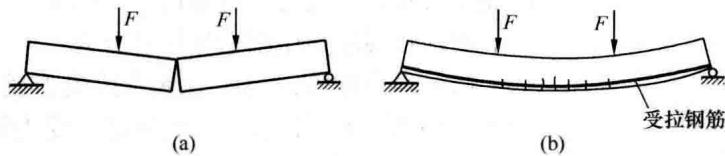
^[33] 素混凝土梁与钢筋混凝土梁的破坏情况对比
